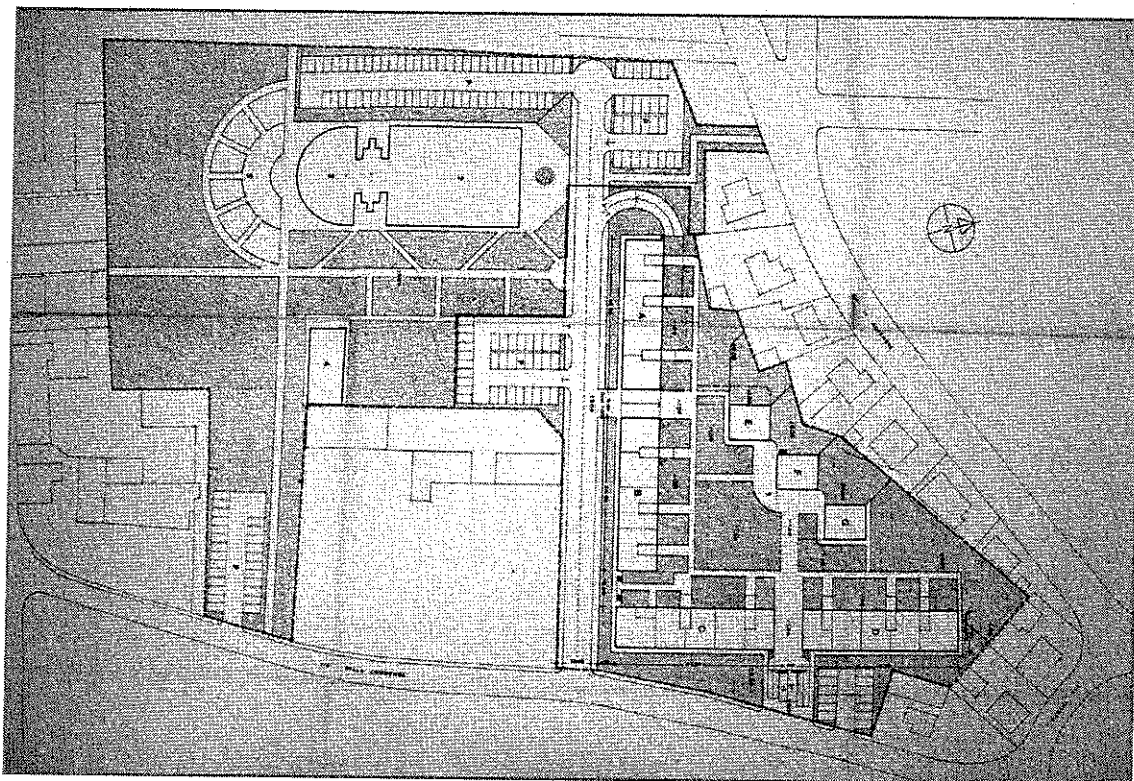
Planimetria del P. Particolareggiato ex Fornace Corradi
